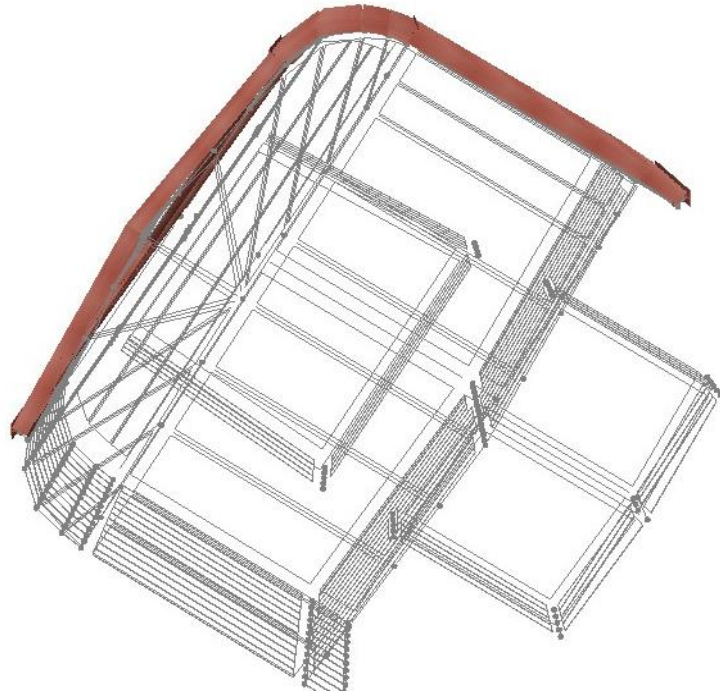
Vista transversal RAM Poderoso completo más estructura.
